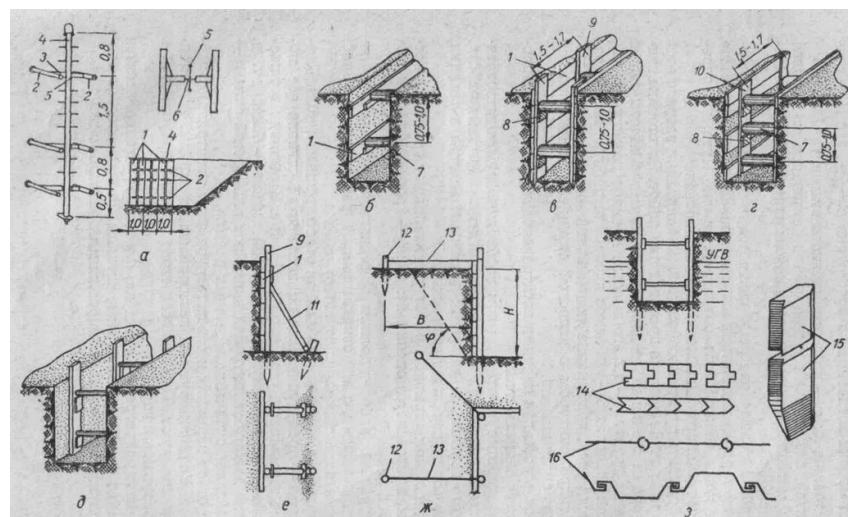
Типи кріплень стінок траншей і котлованів:
